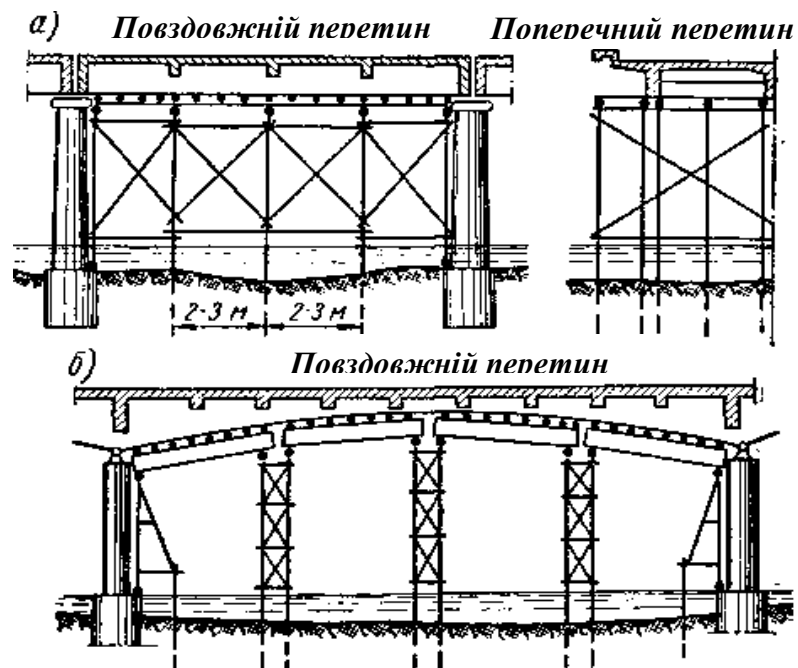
Схеми риштувань для споруди залізобетонних балочних мостів
